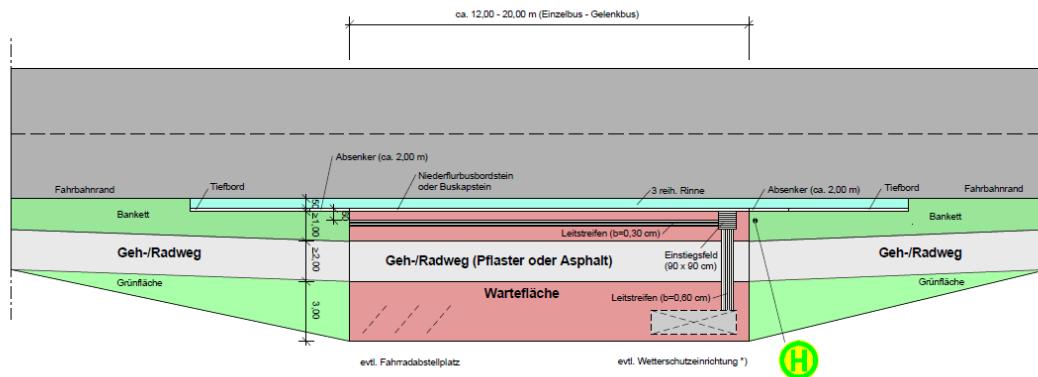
Barrierefreie Bushaltestelle für gering belastete Straßen (außerorts) - Lageplan -
